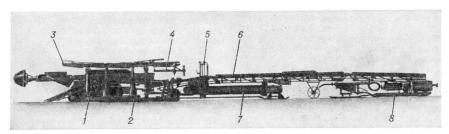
Проведение выработок комбайновым комплексом: 1 — проходческий комбайн; 2 — боковые секции крепи; 3 — перекрытие над комбайном; 4 — кассета для металлической сетки; 5 — бурильная установка для возведения анкерного крепления; 6 — перегружатель ленточный передвижной; 7 — пылеулавливающая установка; 8 — насосная установка.
